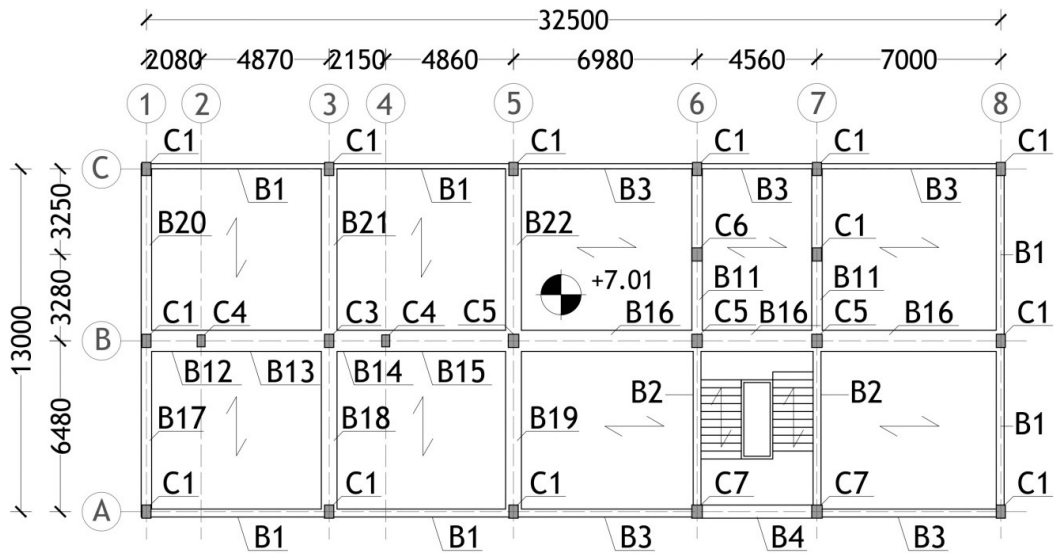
Pianta strutturale del secondo impalcato a quota +7.01 m
